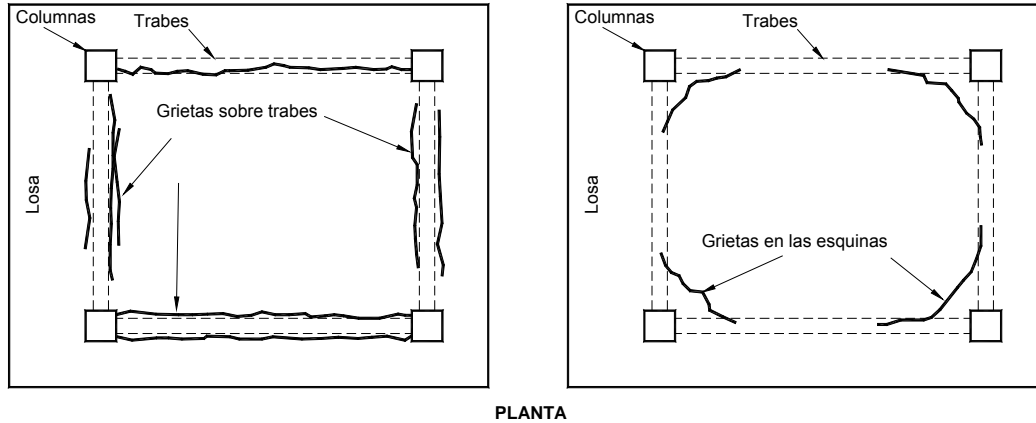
Grietas en losas sobre traves perimetrales y en esquinas
